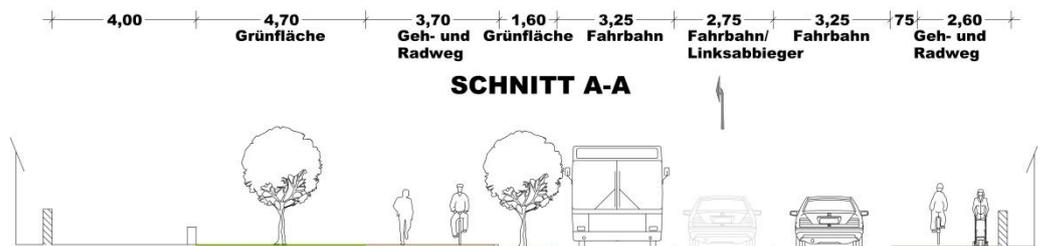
Trassenvariante 1a – Straßenquerschnitt Satower Straße (Bereich nördlich Rennbahnallee)
